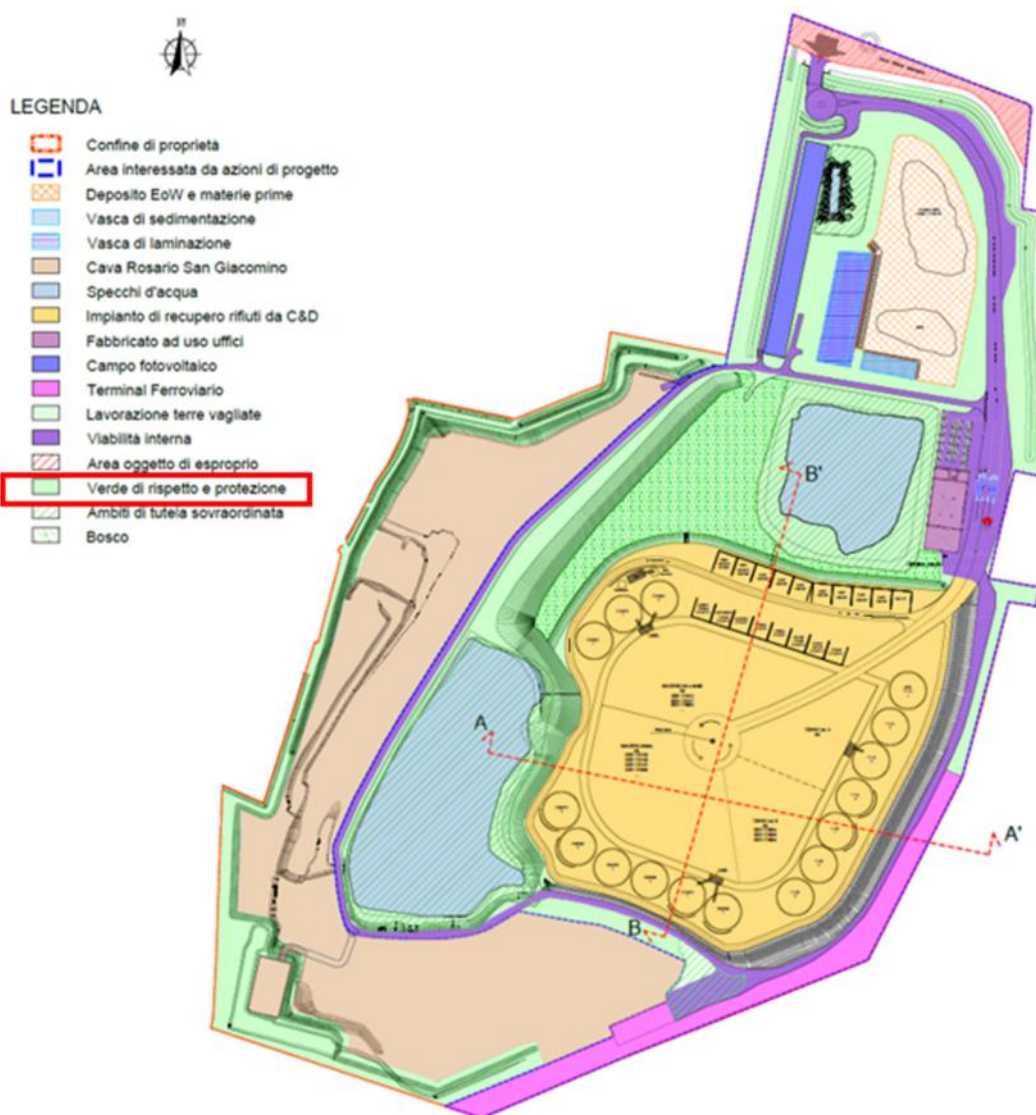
Individuazione verde di rispetto e protezione (stralcio Tav. PF T11)
